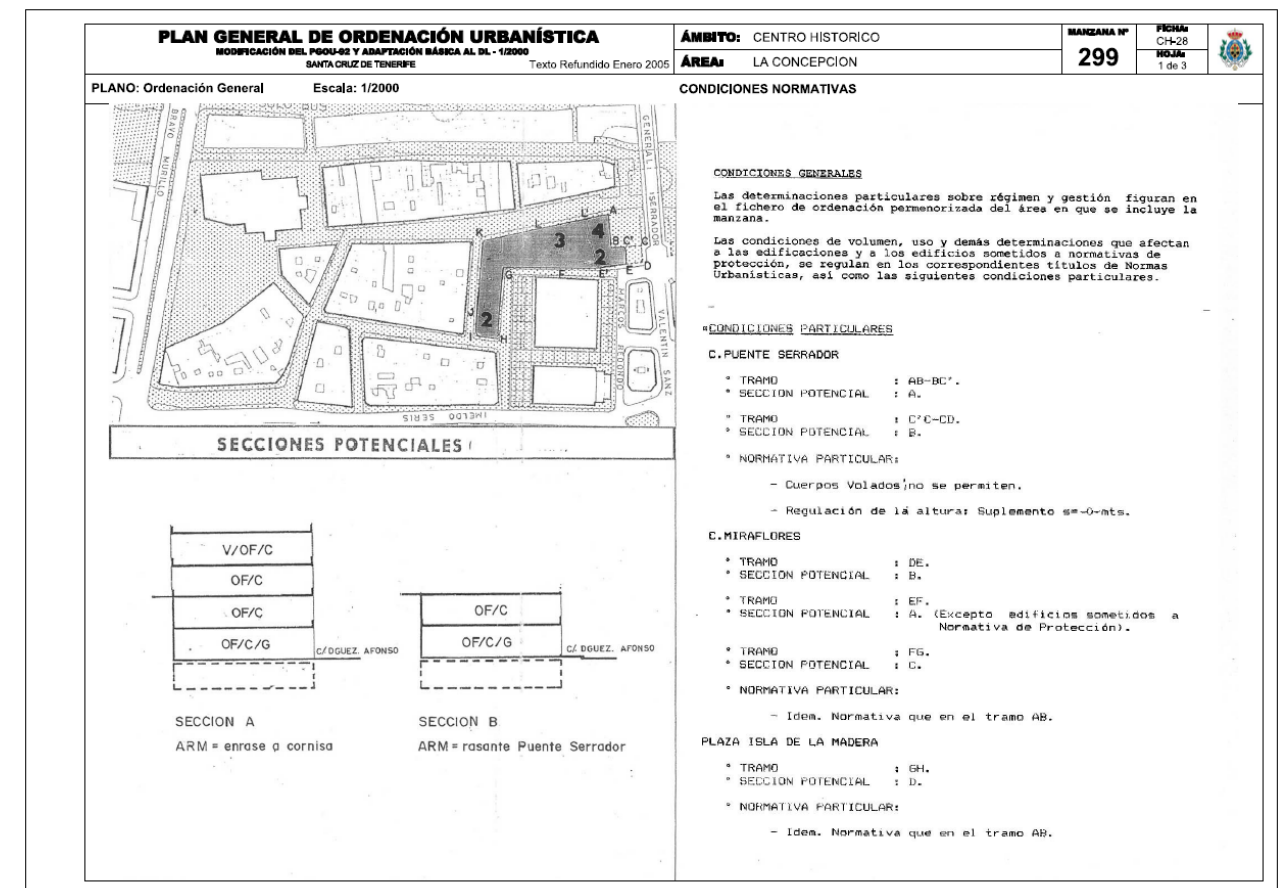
Plano de Ordenación General y Secciones propuestas
